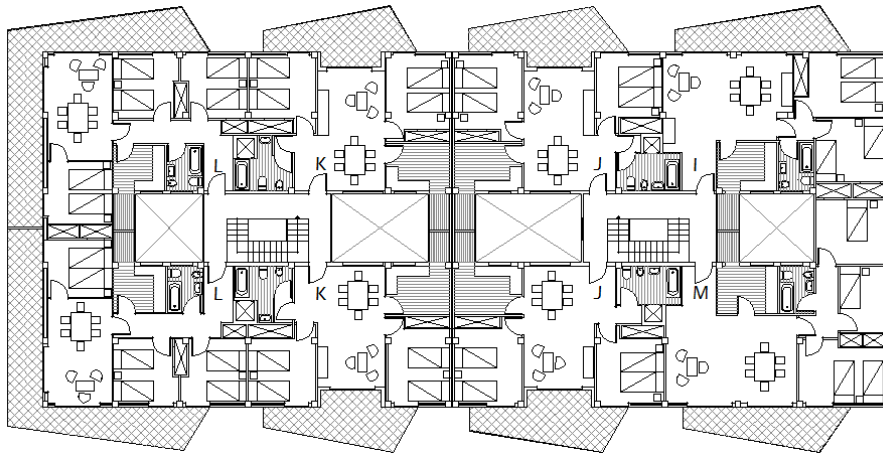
Plano redibujado del original de la planta tipo del bloque X de los Aptamentos Costa Blanca. *Fuente propia.
